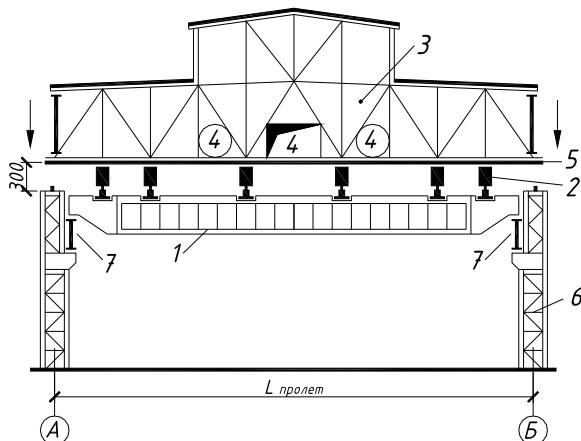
Схема монтажа блоков покрытия промышленного здания с использованием низкого установщика:
